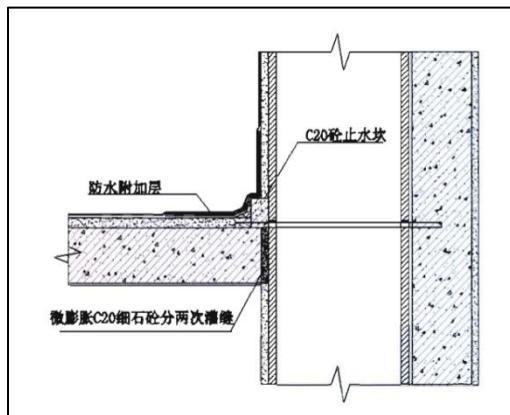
卫生间竖向排气道防渗漏节点构造示意图
